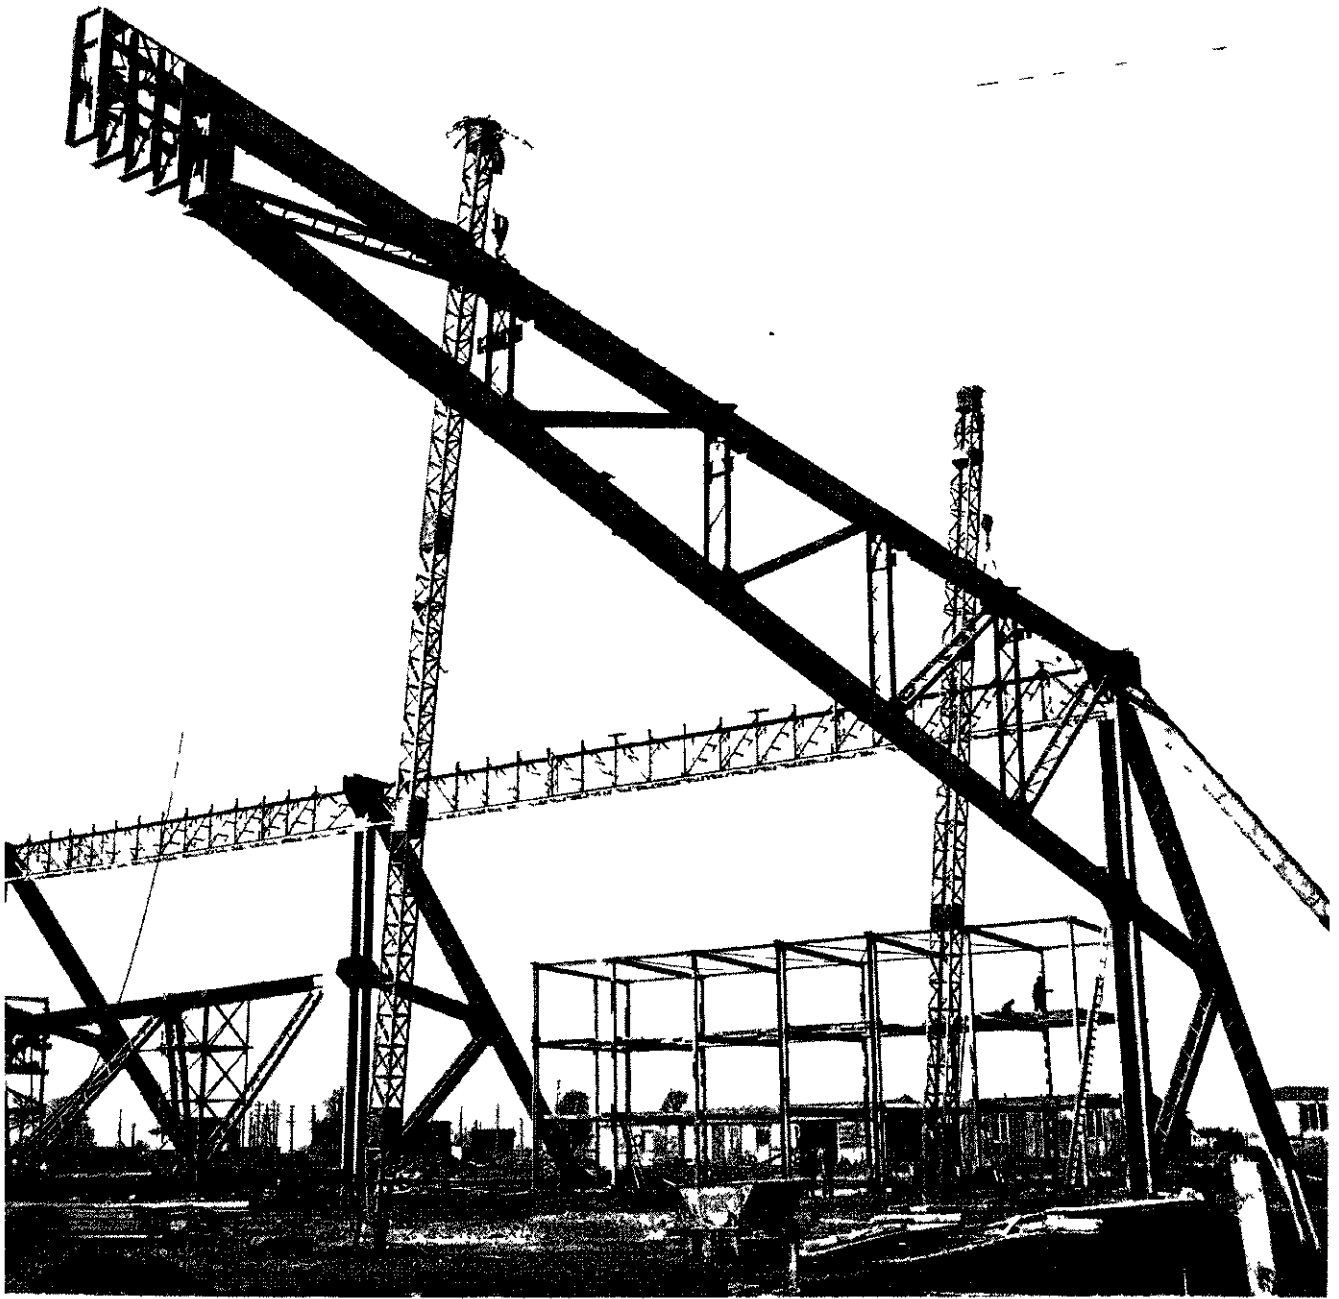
Poutre maîtresse en cours de levage (Prise le 1-3-1954)
